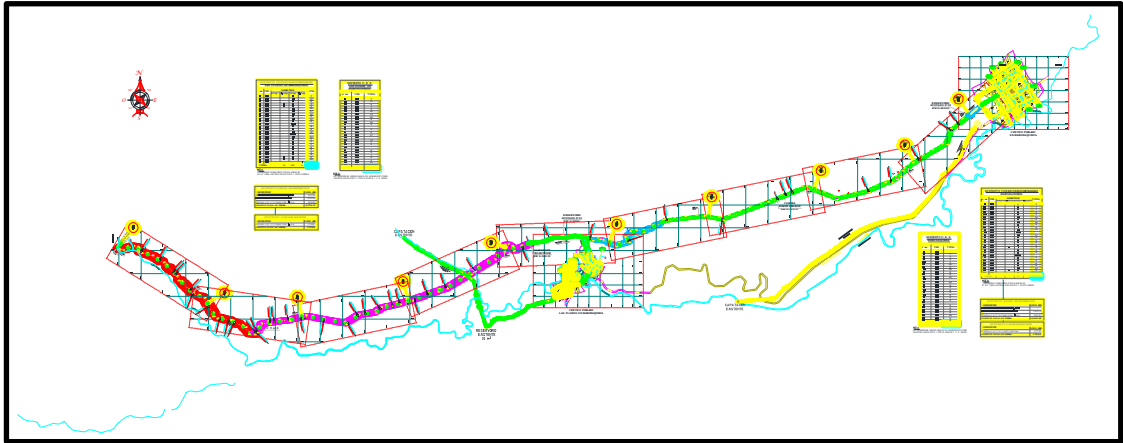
Planteamiento General del Sistema de drenaje pluvial.
